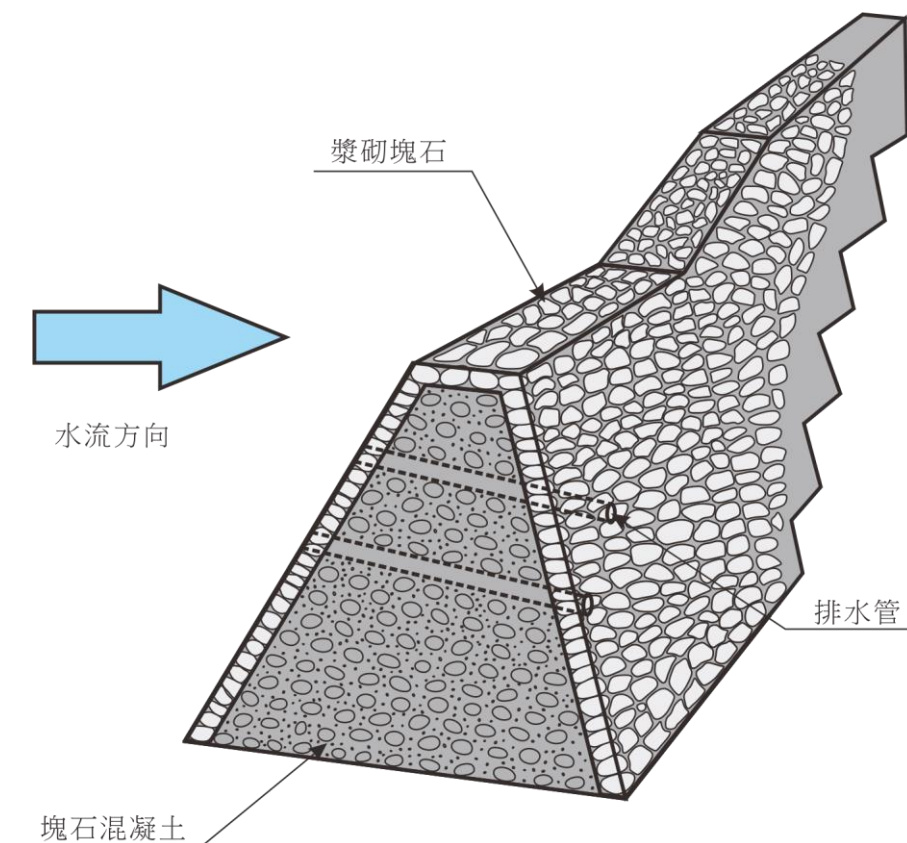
砌塊石壩面塊石混凝土填心壩剖面示意圖
